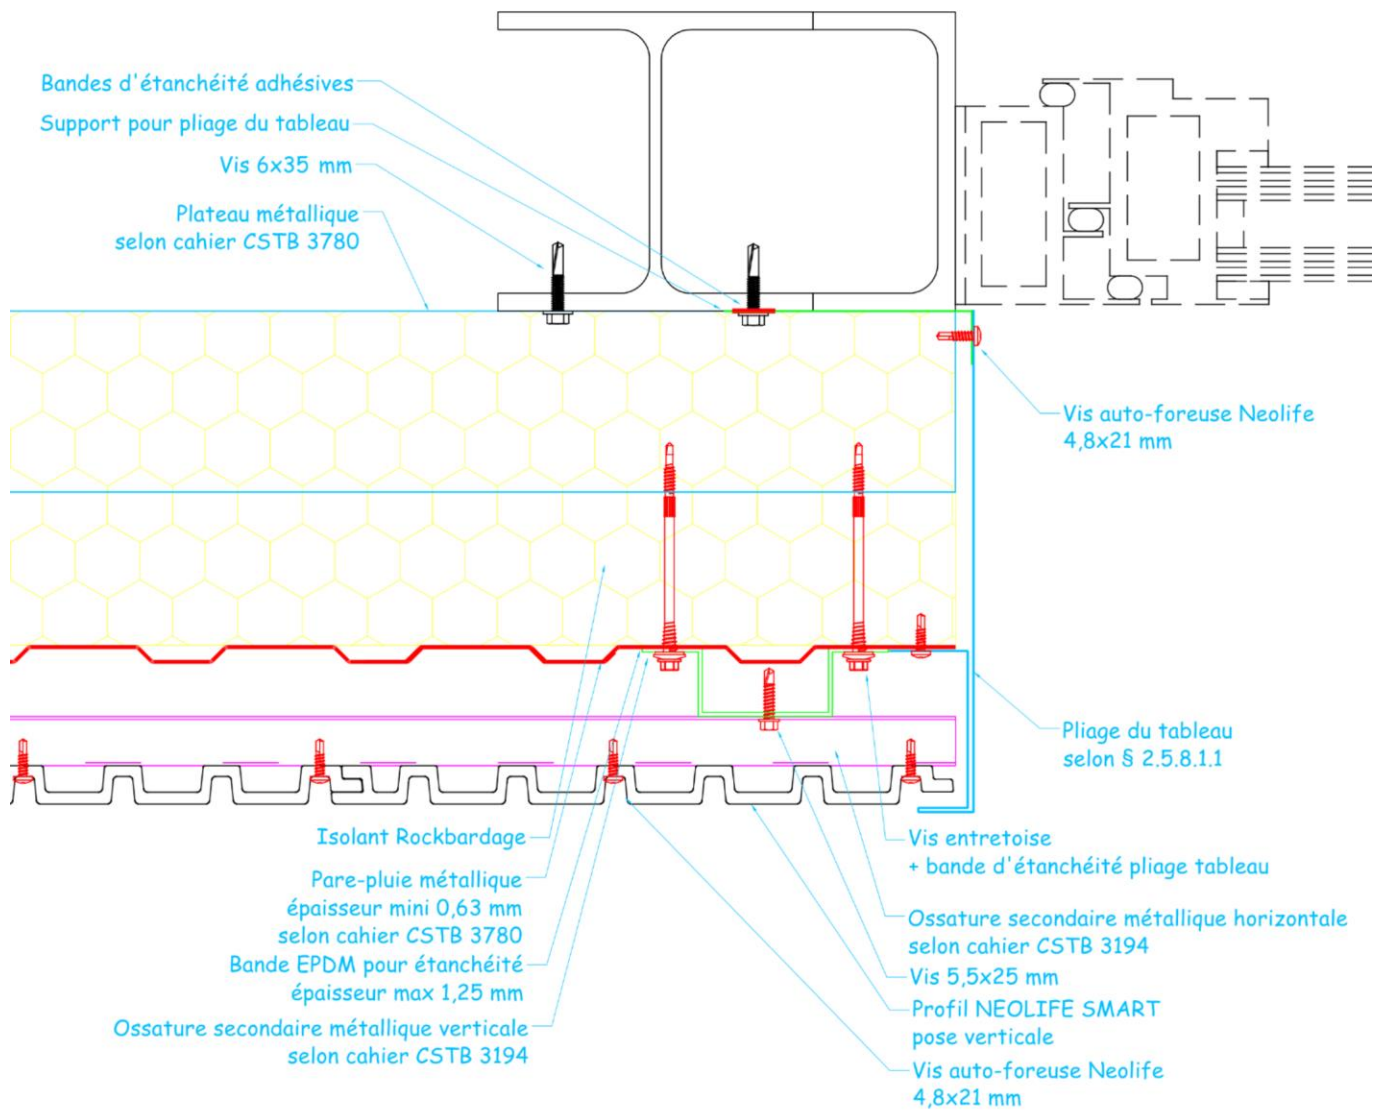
is - Appui de baie (coupe verticale) – Pose verticale
